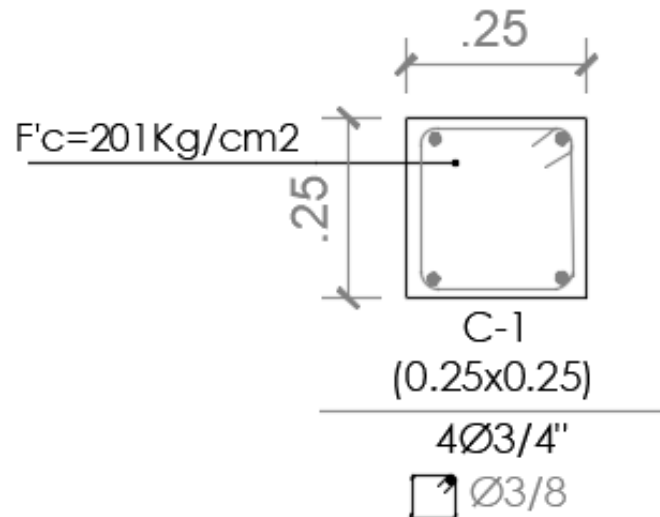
Dimensión de columnas de 0.25 x 0.25 m
